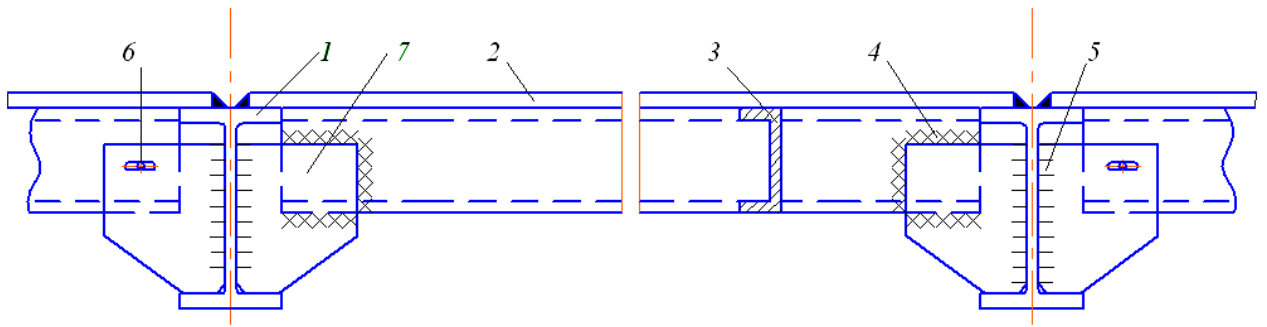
Конструкция соединения балки настила с главными балками:
